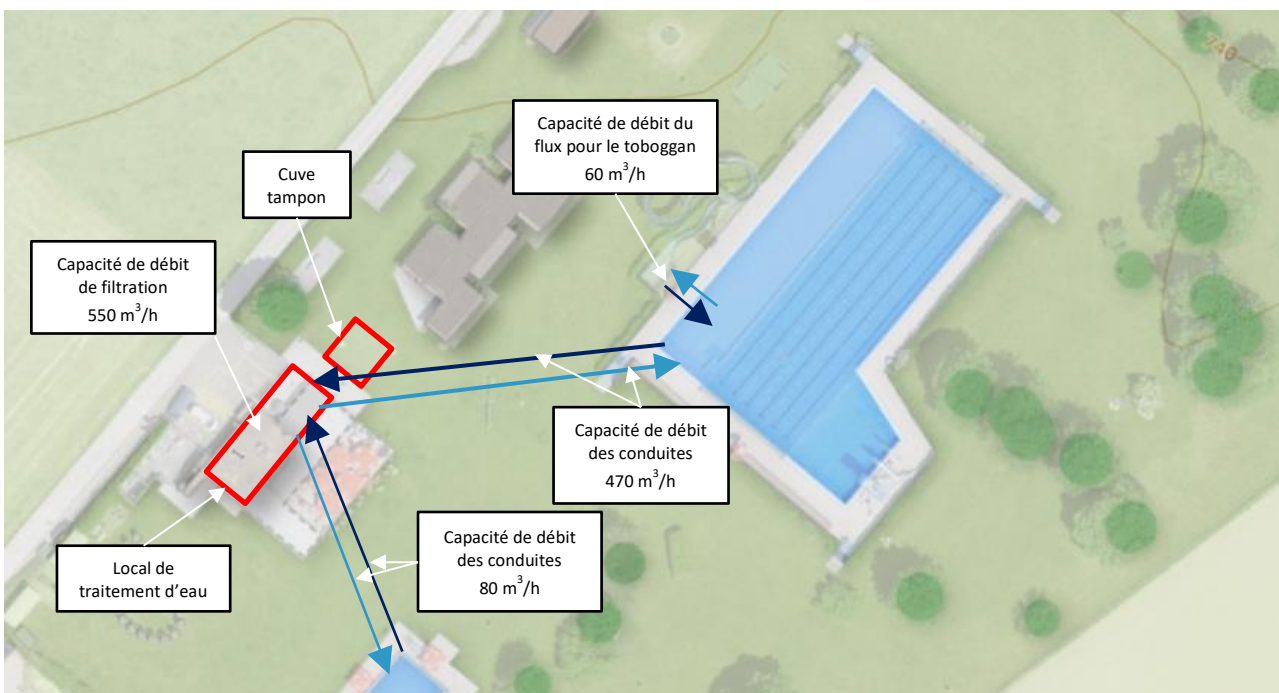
Plan de situation actuel des installations et flux d'eau
